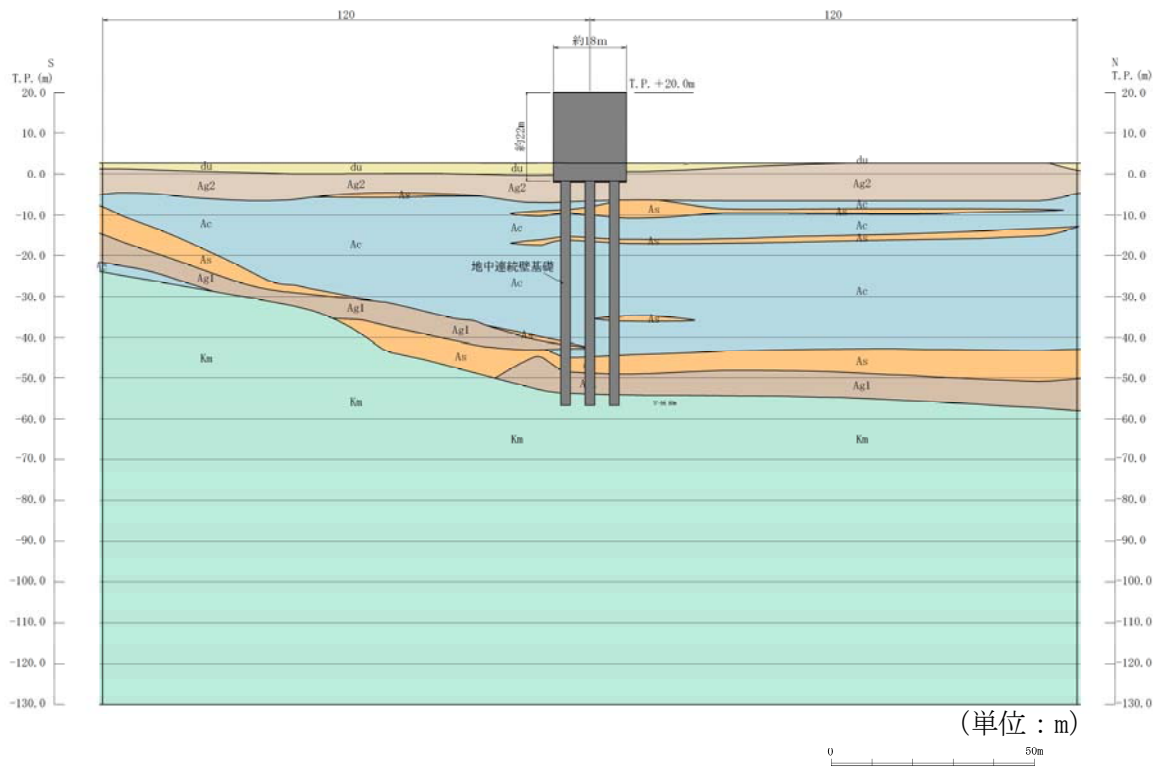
(5) 鉄筋コンクリート防潮壁 断面図(E-E断面)
